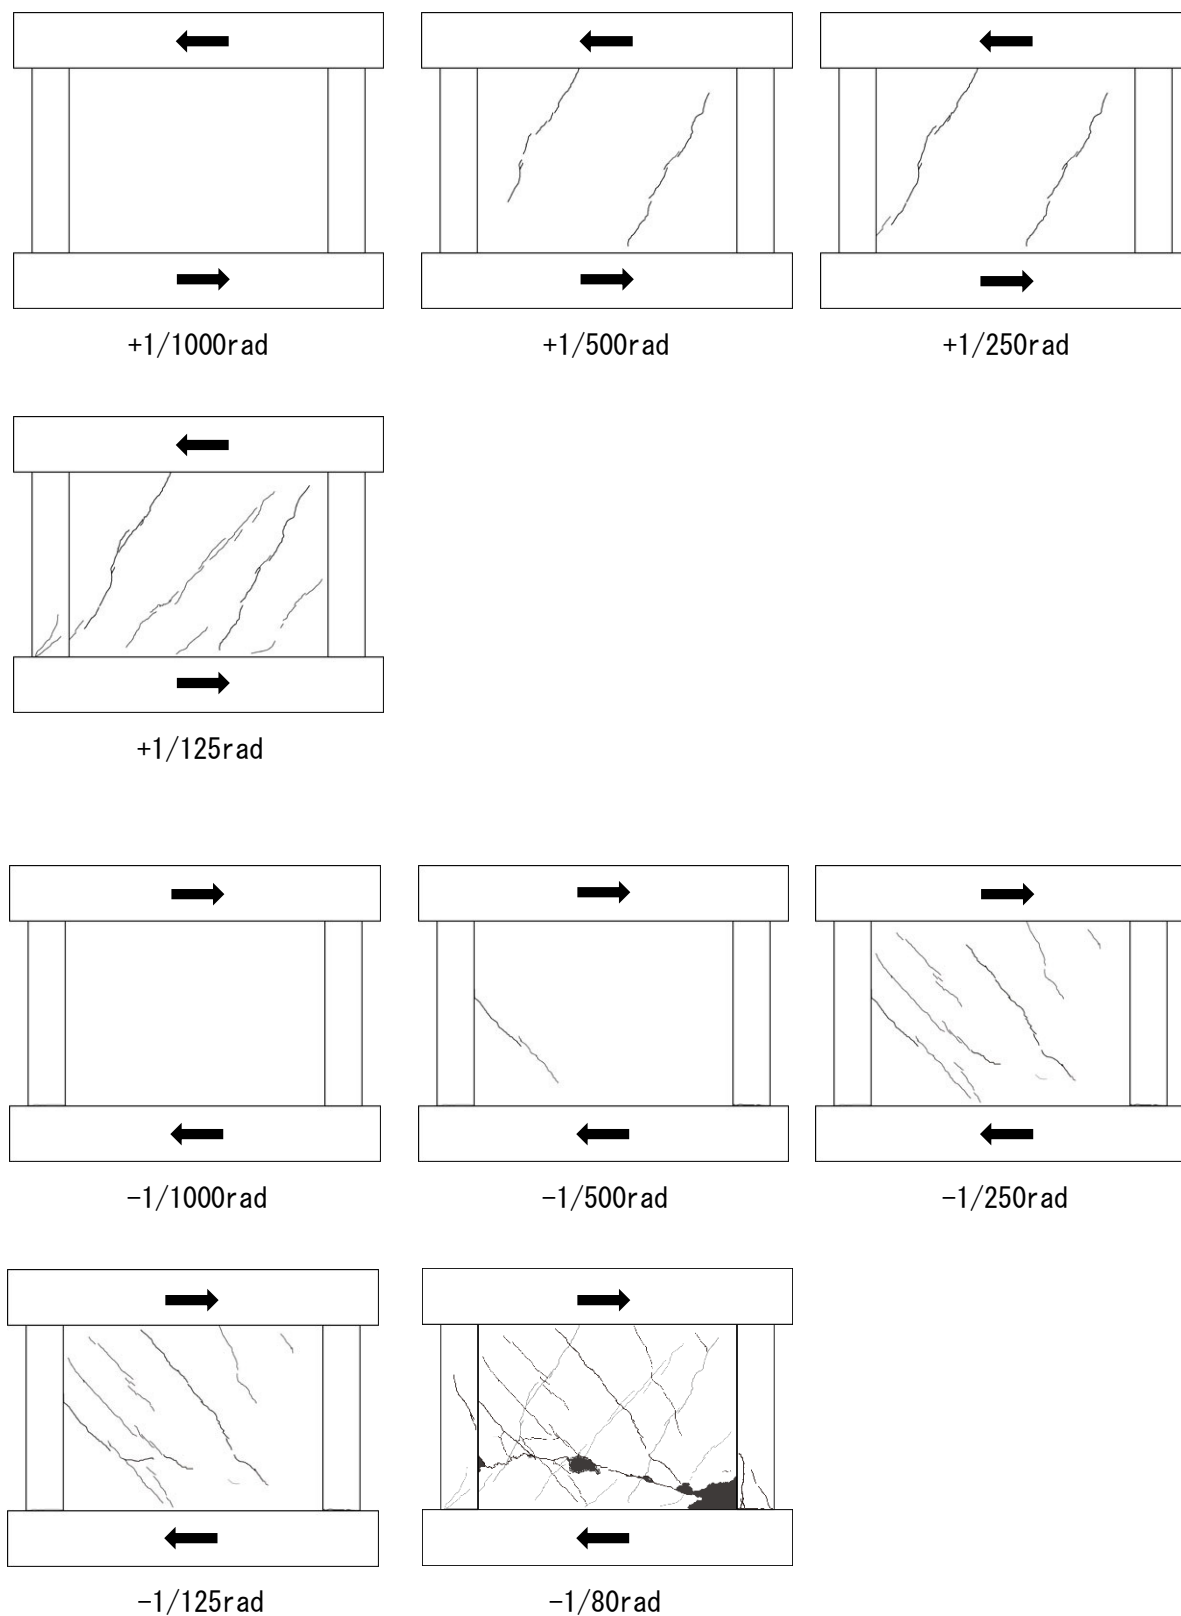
各層間変形角のひび割れ状況図 (F7-W-1.5)
